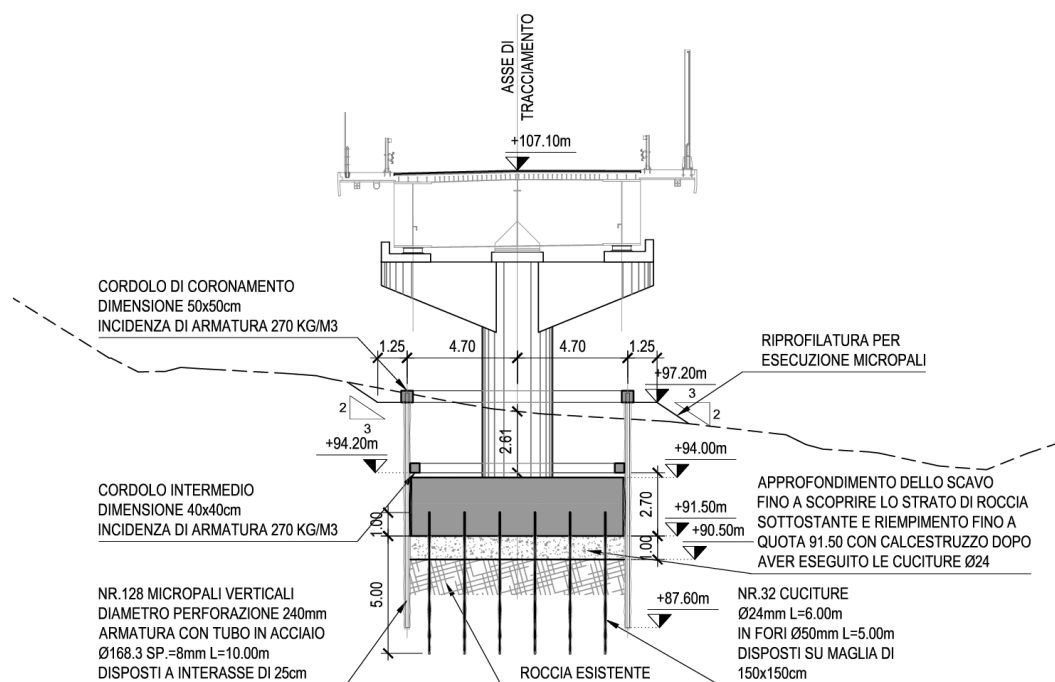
Sezione tipo opera provvisoriale pila 1.
